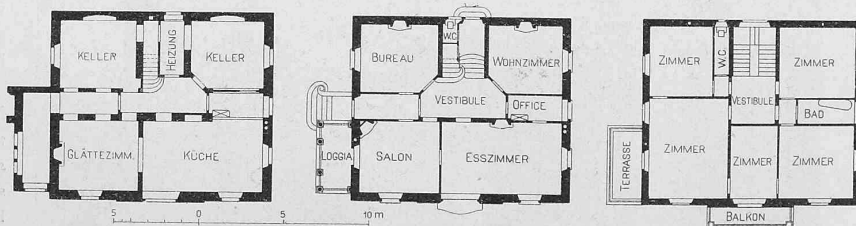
Grundrisse vom Keller-, Erd- und Obergeschoss der Villa Soldati in Neggio. — 1:400.
